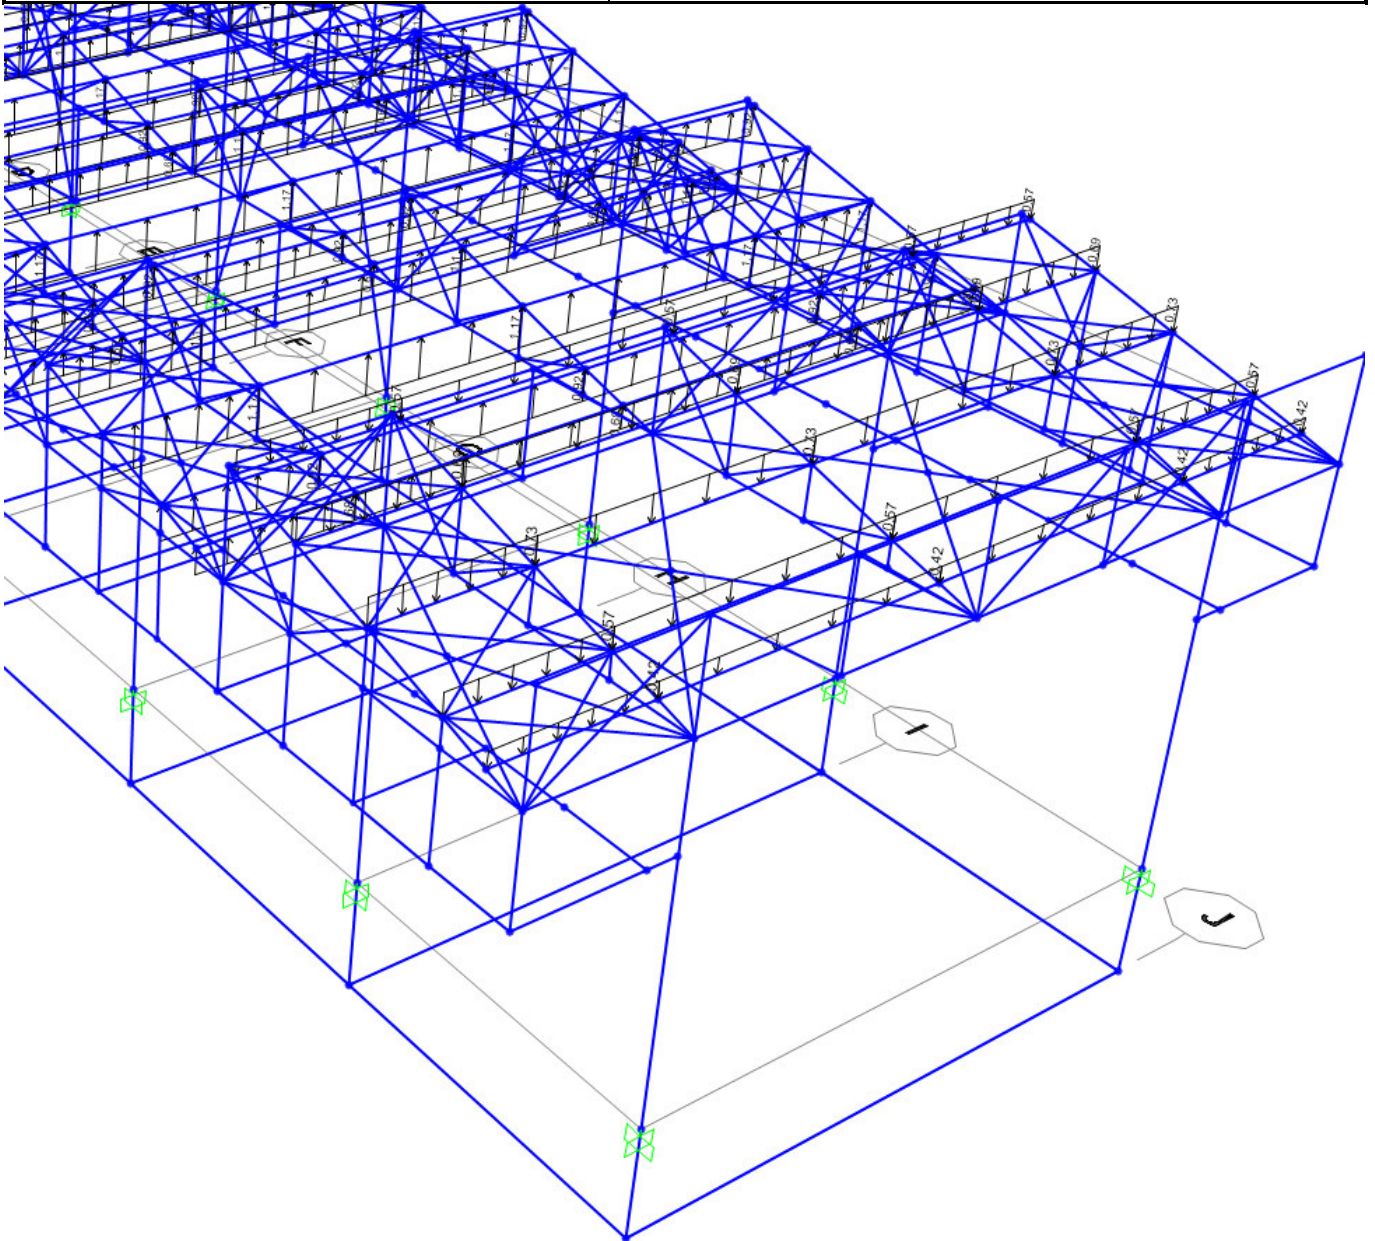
Azione del vento agente in direzione longitudinale (X-1)
